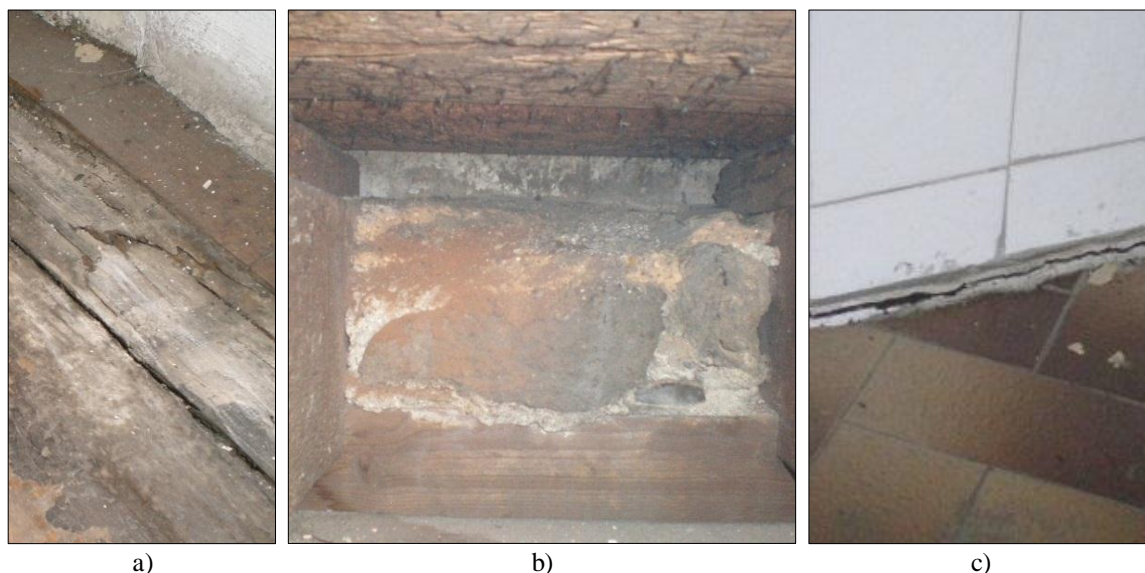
Pavimento do edifício estudado. a) Frinchas entre elementos do soalho. b) Apoio dos vigamentos do pavimento sobre um frechal com descarga na parede exterior. c) Frincha na ligação entre o pavimento e a parede interior, devido ao assentamento do pavimento.
